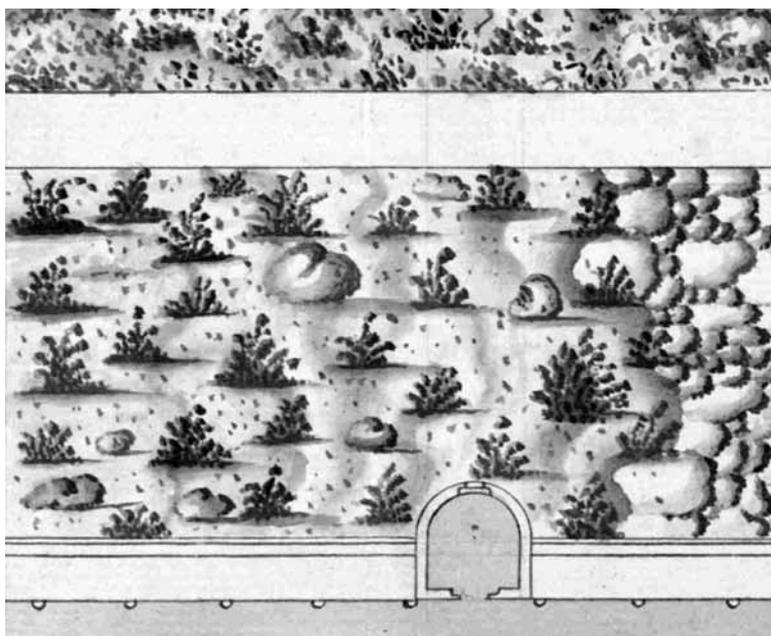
Diego García Conde, Plano, planta y alzado, puente del Río de la Antigua (detalle). Fuente: AGN, Fomento Caminos, 6, 1º Pte., fc., 221 bis.
